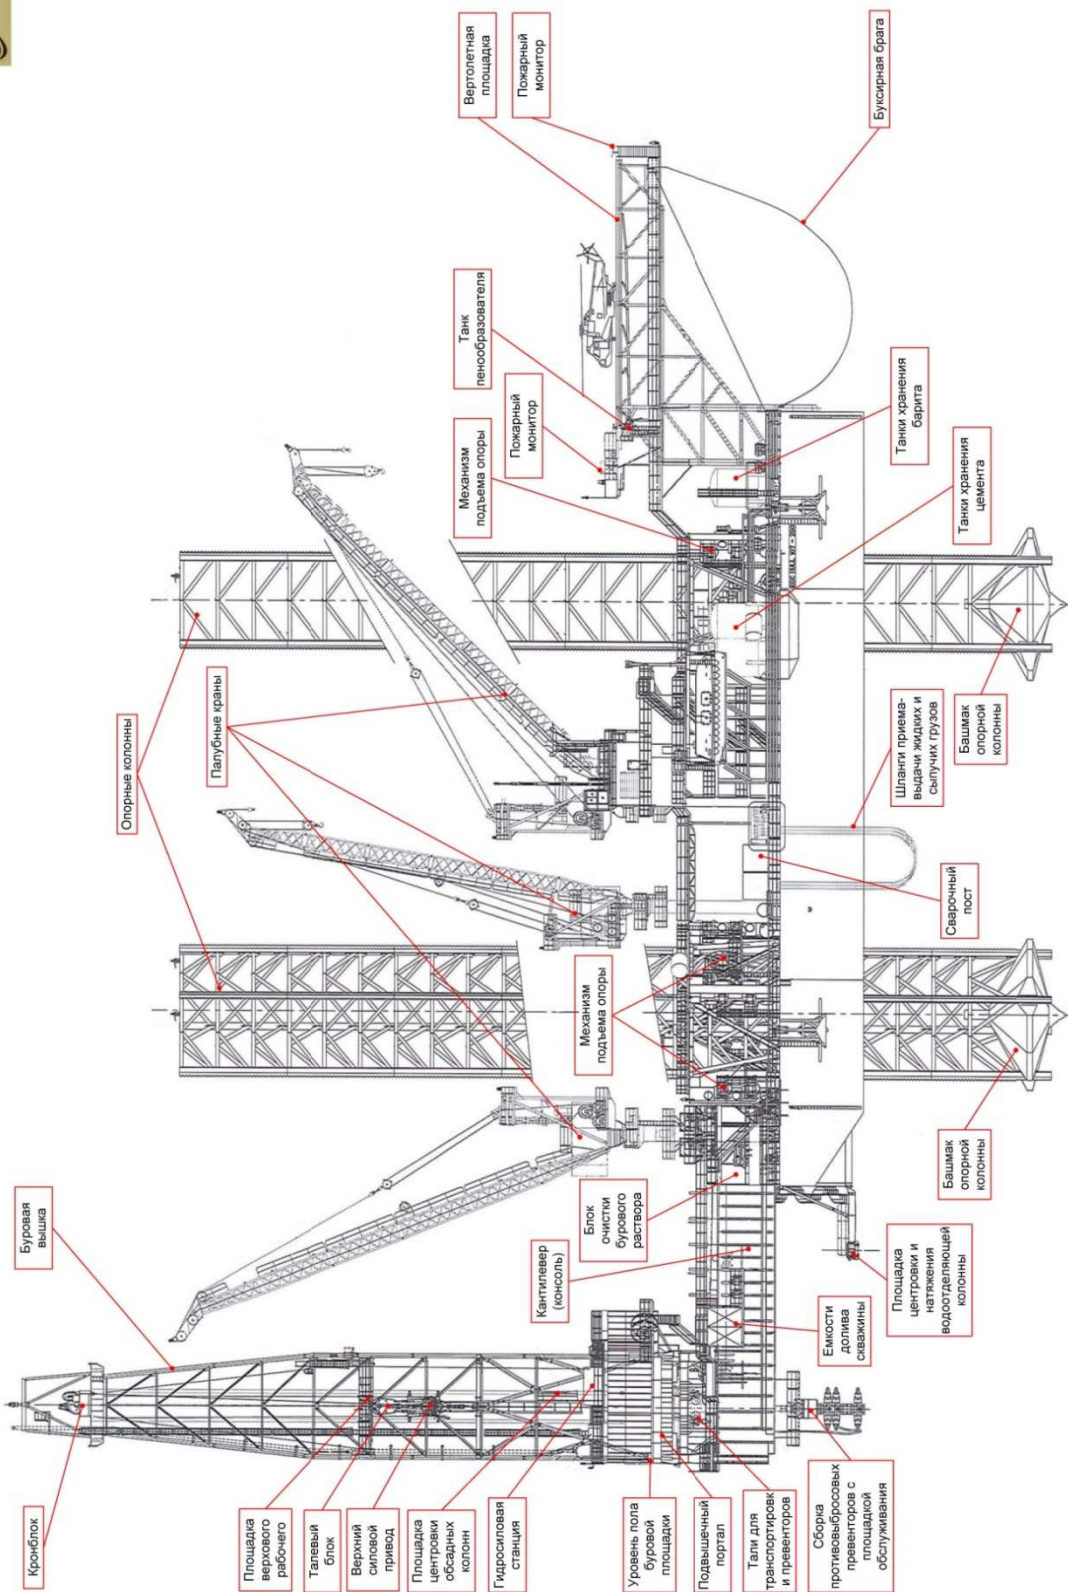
Схема общего расположения оборудования. Вид с правого борта
